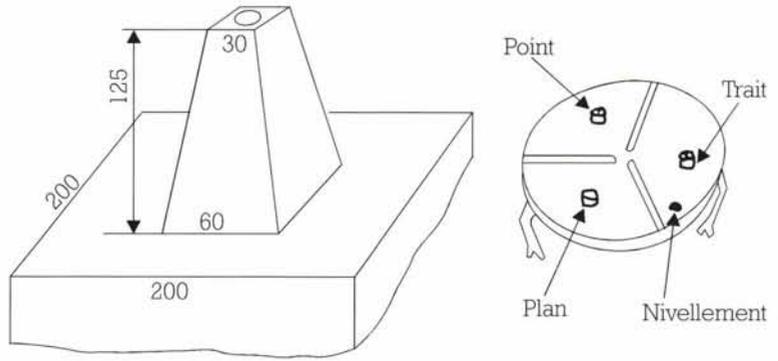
Pilier d'observation topographique et plaque de centrage.
